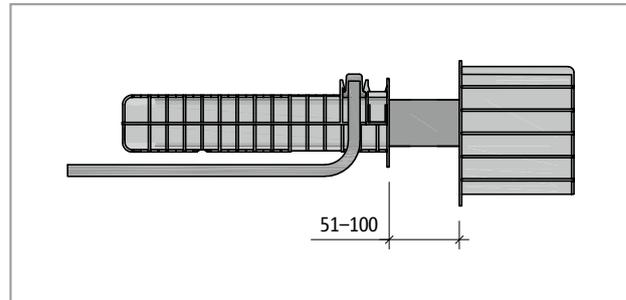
Schöck Tronsole® Typ Q...-XL: Einbauvariante Fugenbreite 51-100 mm
